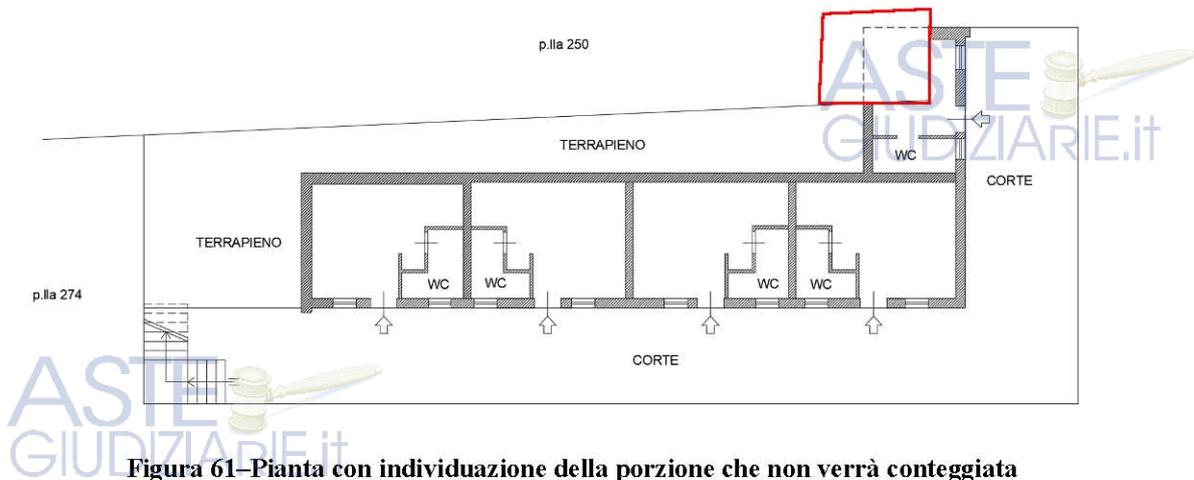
Pianta con individuazione della porzione che non verrà conteggiata
